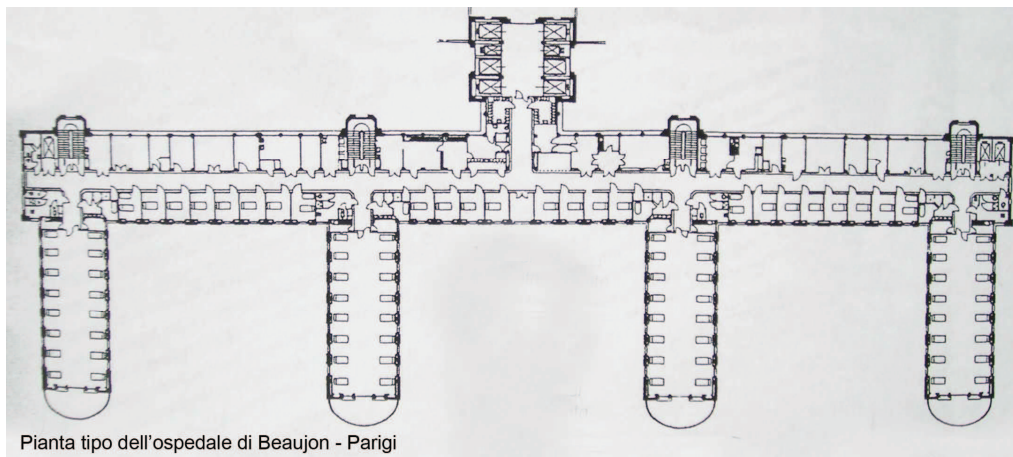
Pianta dell'Ospedale di Beaujon - Parigi
